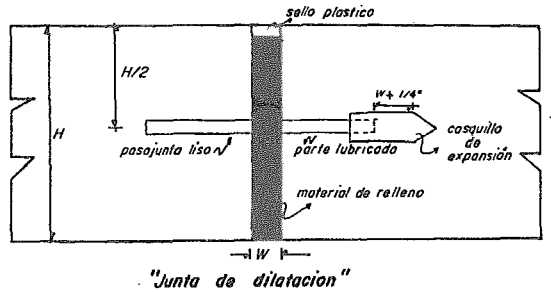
b, TIPOS DE JUNTAS
